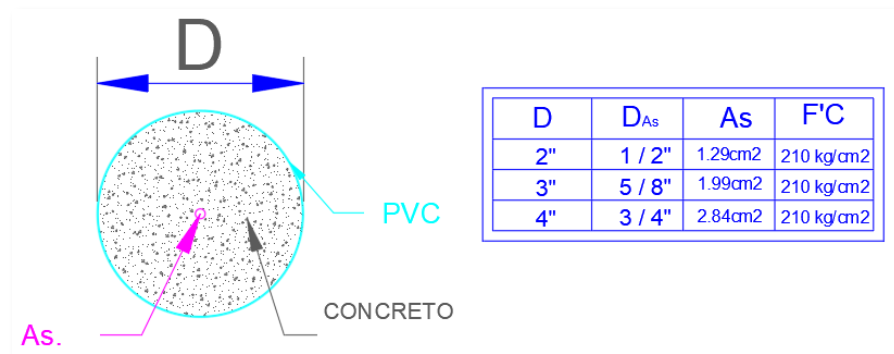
Esquema de sección compuesta. Detalle de sección del elemento compuesto por acero, concreto y PVC.
